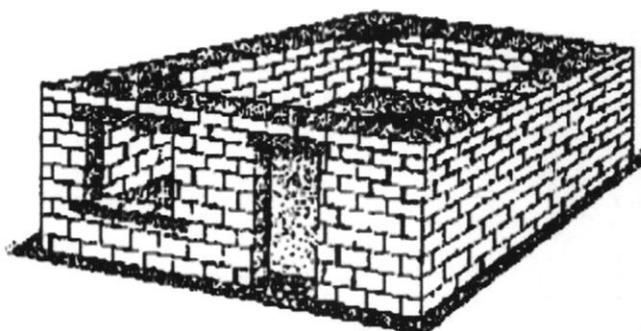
Protección de la parte superior de la pared de adobe.
